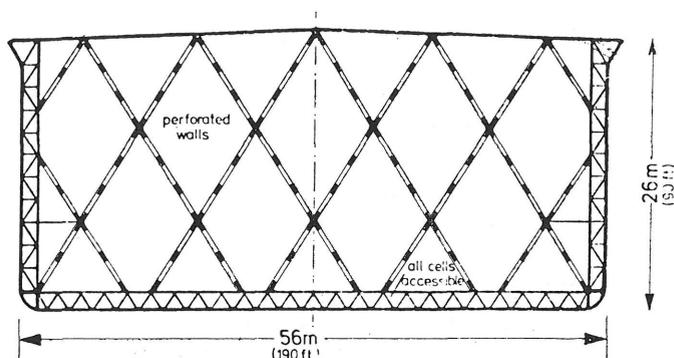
Sección transversal de un petrolero de hormigón pretensado.
